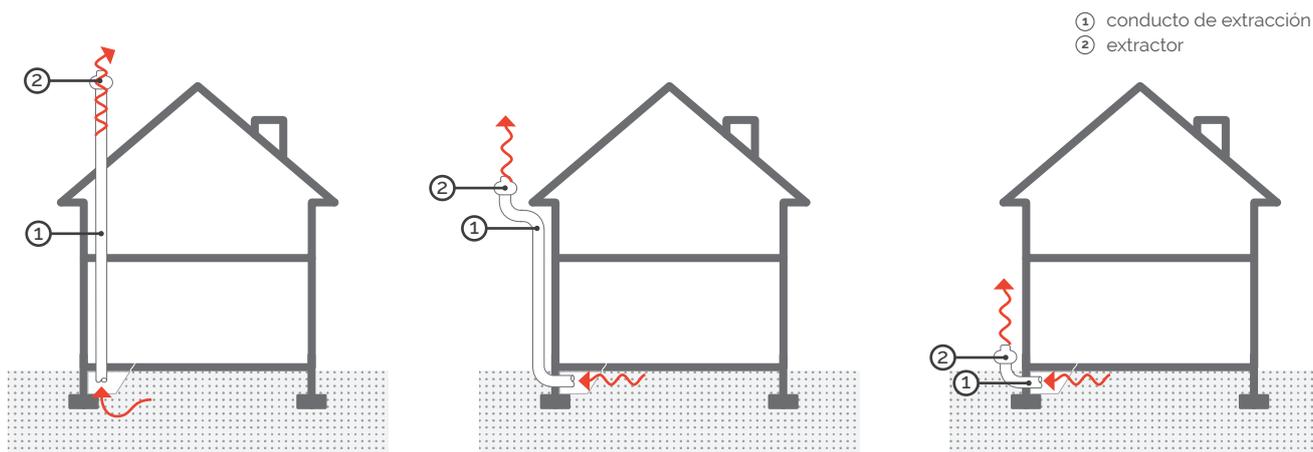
Conducto de extracción a cubierta por el interior del edificio (izda.) y por el exterior (centro) y a fachada (drcha.)
